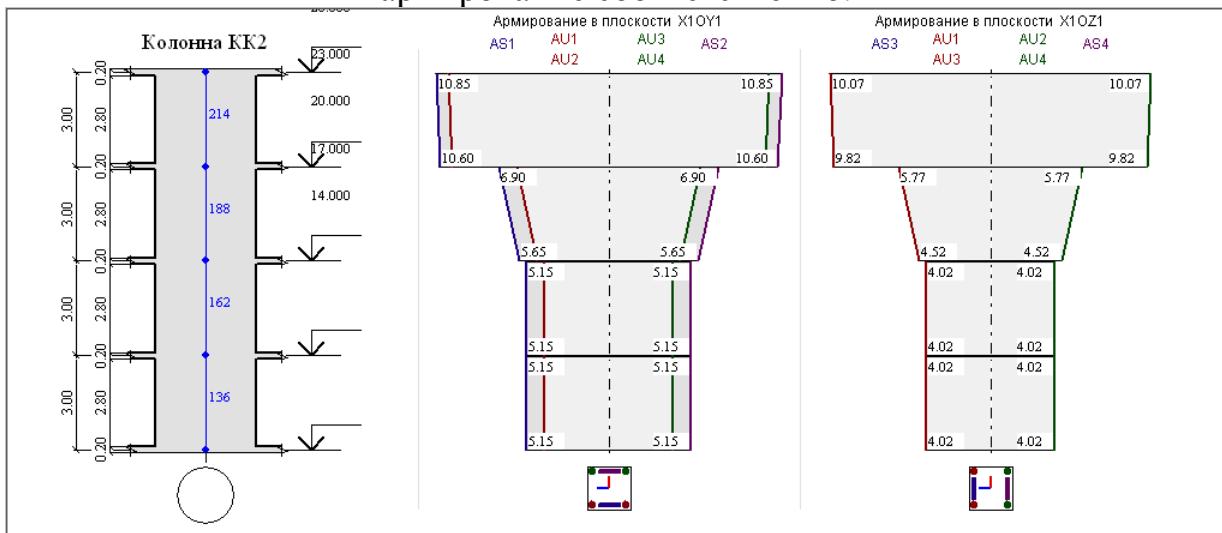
Армирование колонны 6-9 этажей схемы. Поперечное и продольное армирование соответственно.
